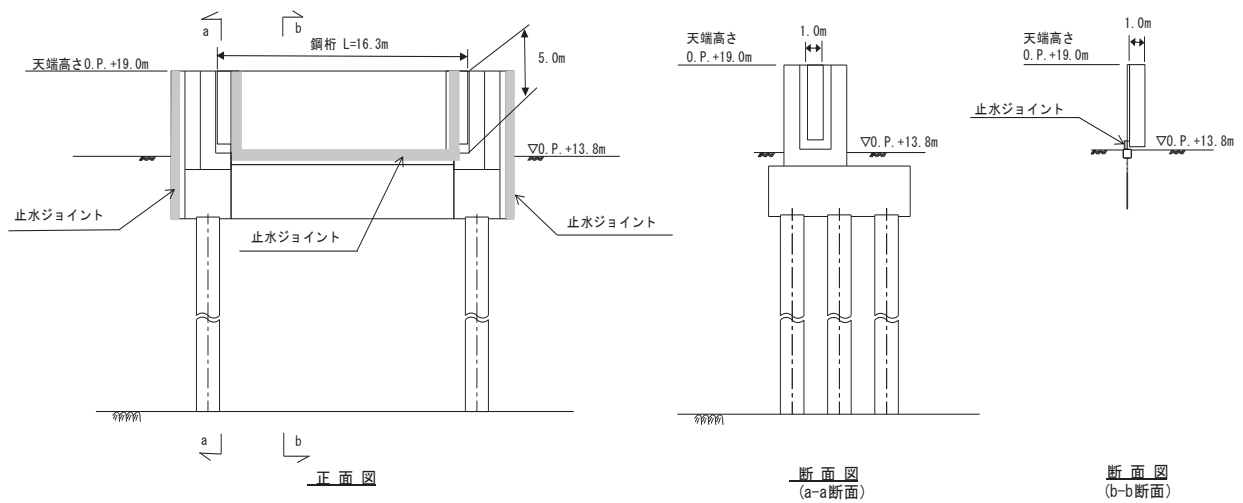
鋼製遮水壁（鋼桁 6） 正面図及び断面図
